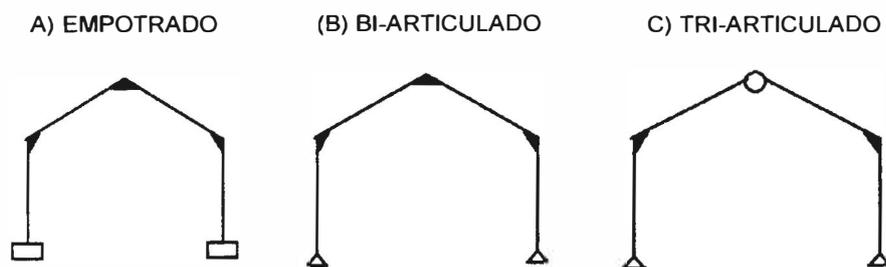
Pórticos con vigas laminadas o soldadas
